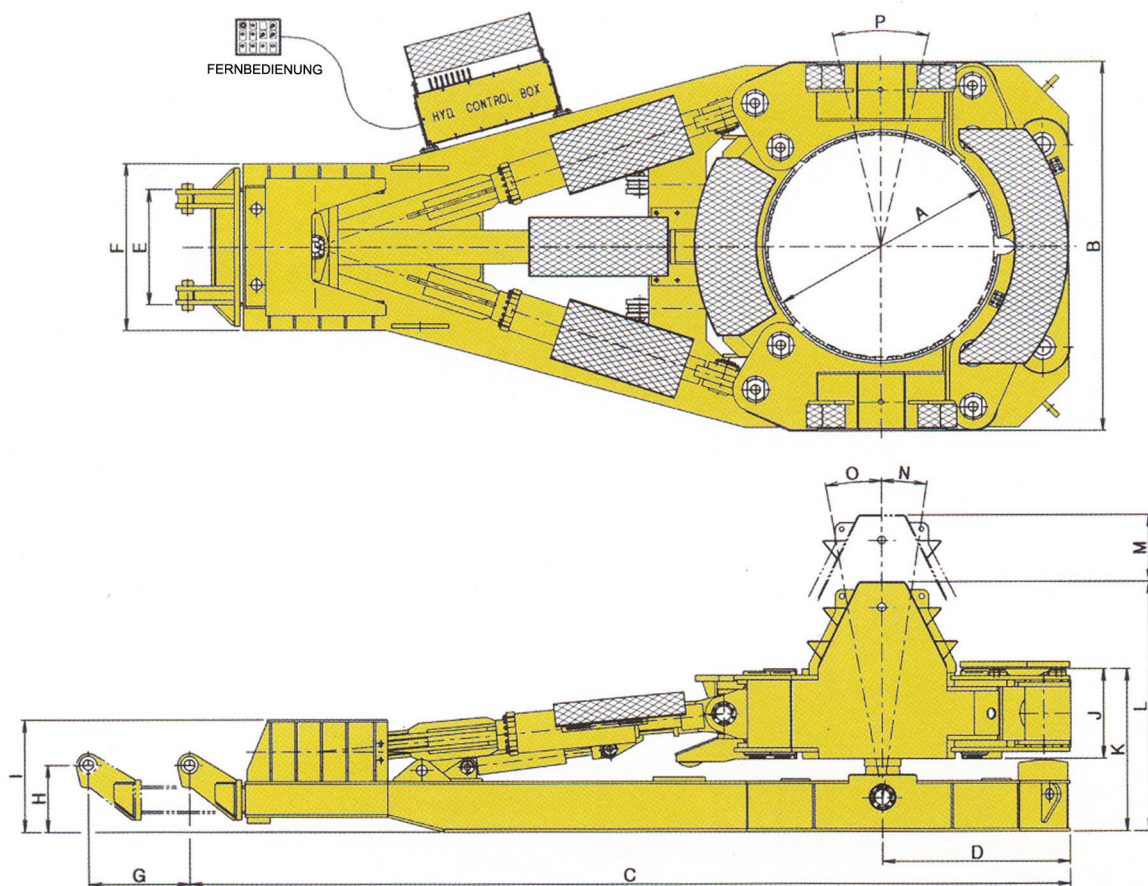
Hydraulische Verrohrungsmaschine (VRM) [22]
